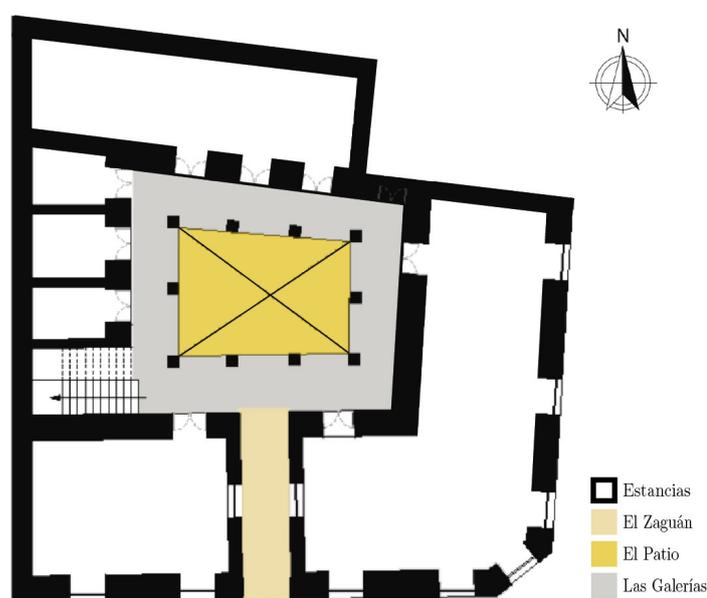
Planta baja de una casa colonial y su distribución espacial
